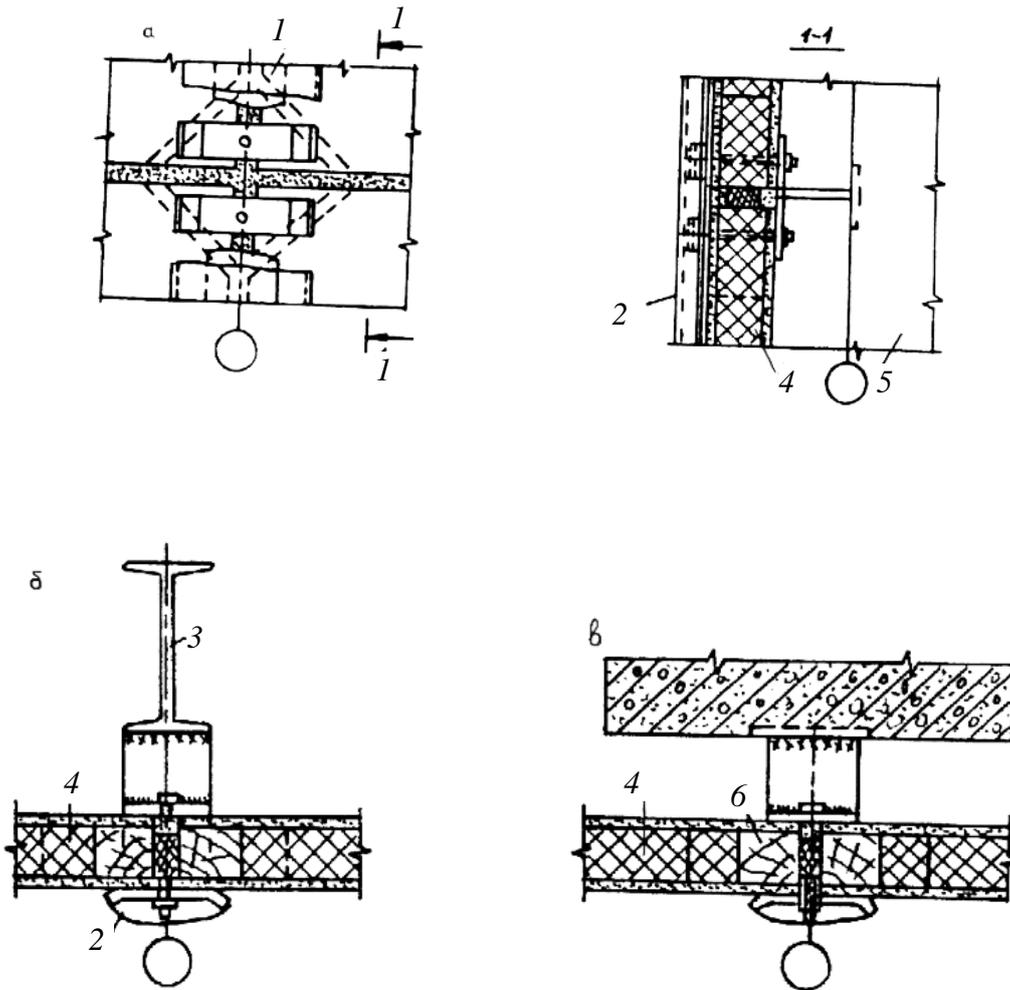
Крепление легкобрасываемых стеновых панелей к каркасу здания на клямерах:
